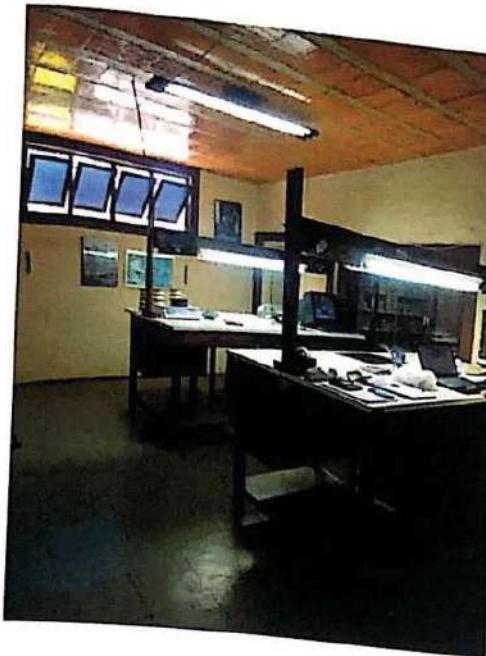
Escritório/Administração – Sala de Classificação de Café – Piso em Ardósia e laje.
